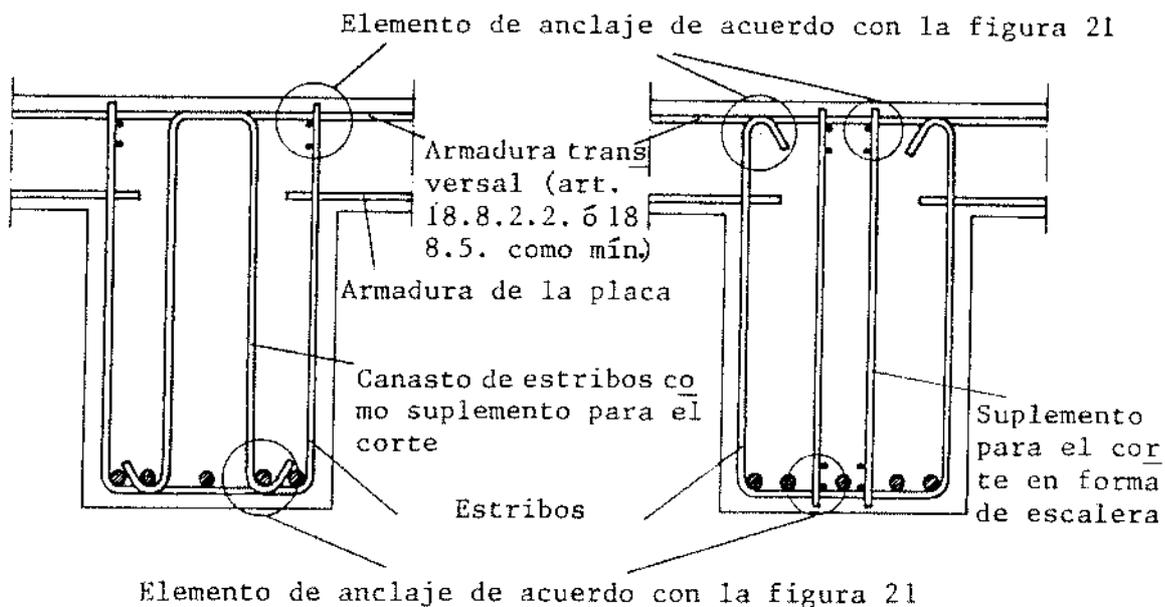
Ejemplo de una armadura para el corte en una viga placa formada por estribos y suplementos para el corte.
